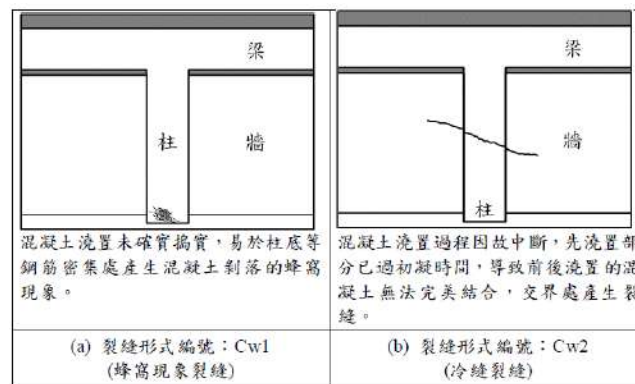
柱構件施工不良之裂縫示意圖[2.1]
